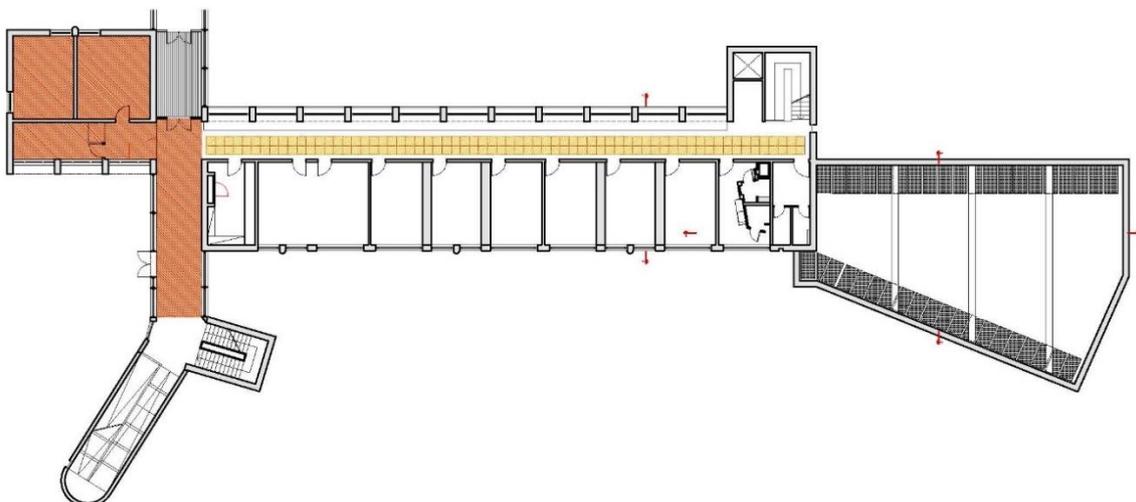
COMPARATIVA – Pianta dei controsoffitti piano primo
